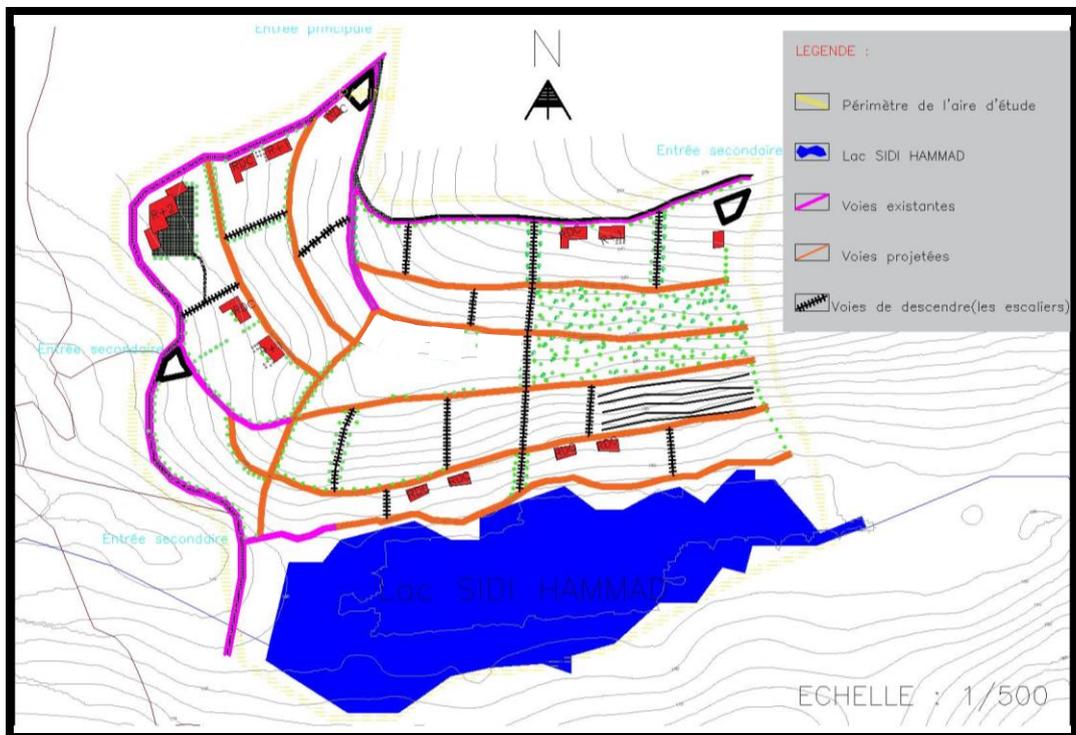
32: Schéma de structure viaire du site d'intervention.
